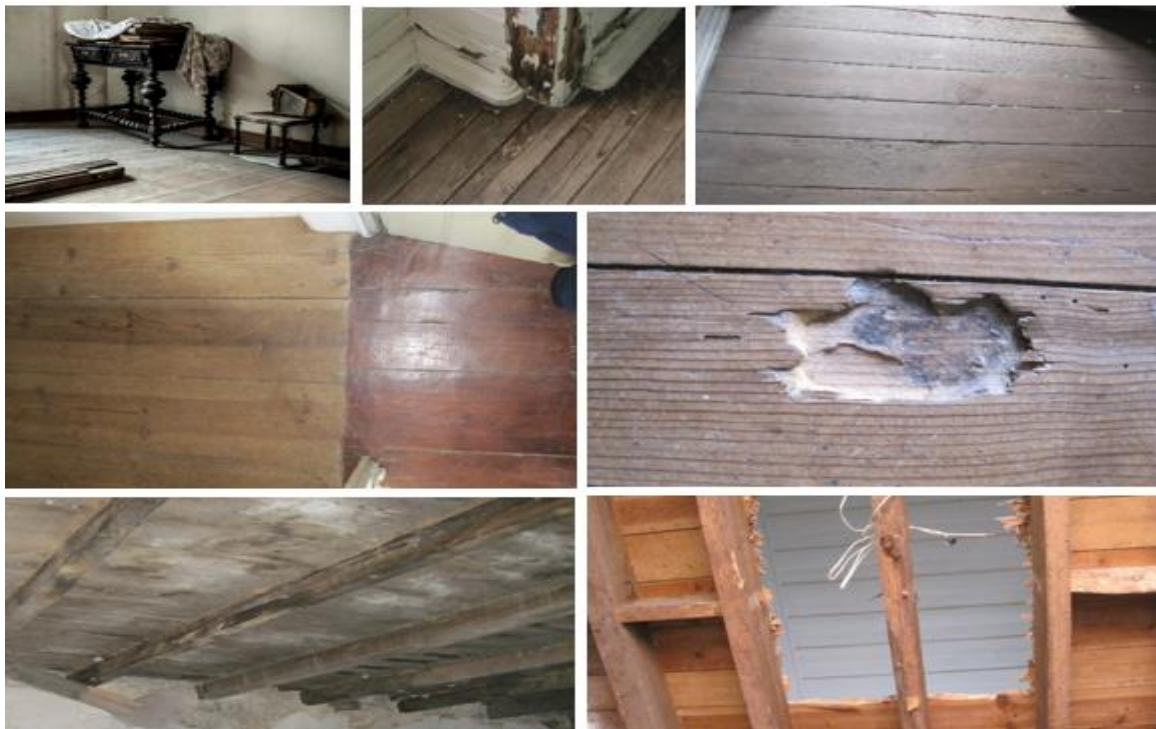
Exemplos de anomalias em pavimentos de madeira do edificado do CHL
